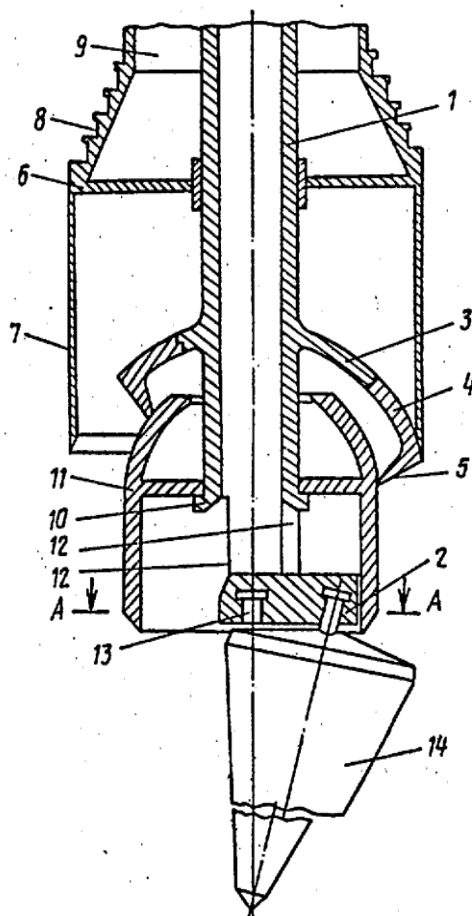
Устройство для изготовления набивной сваи-оболочки с коническим рабочим органом
